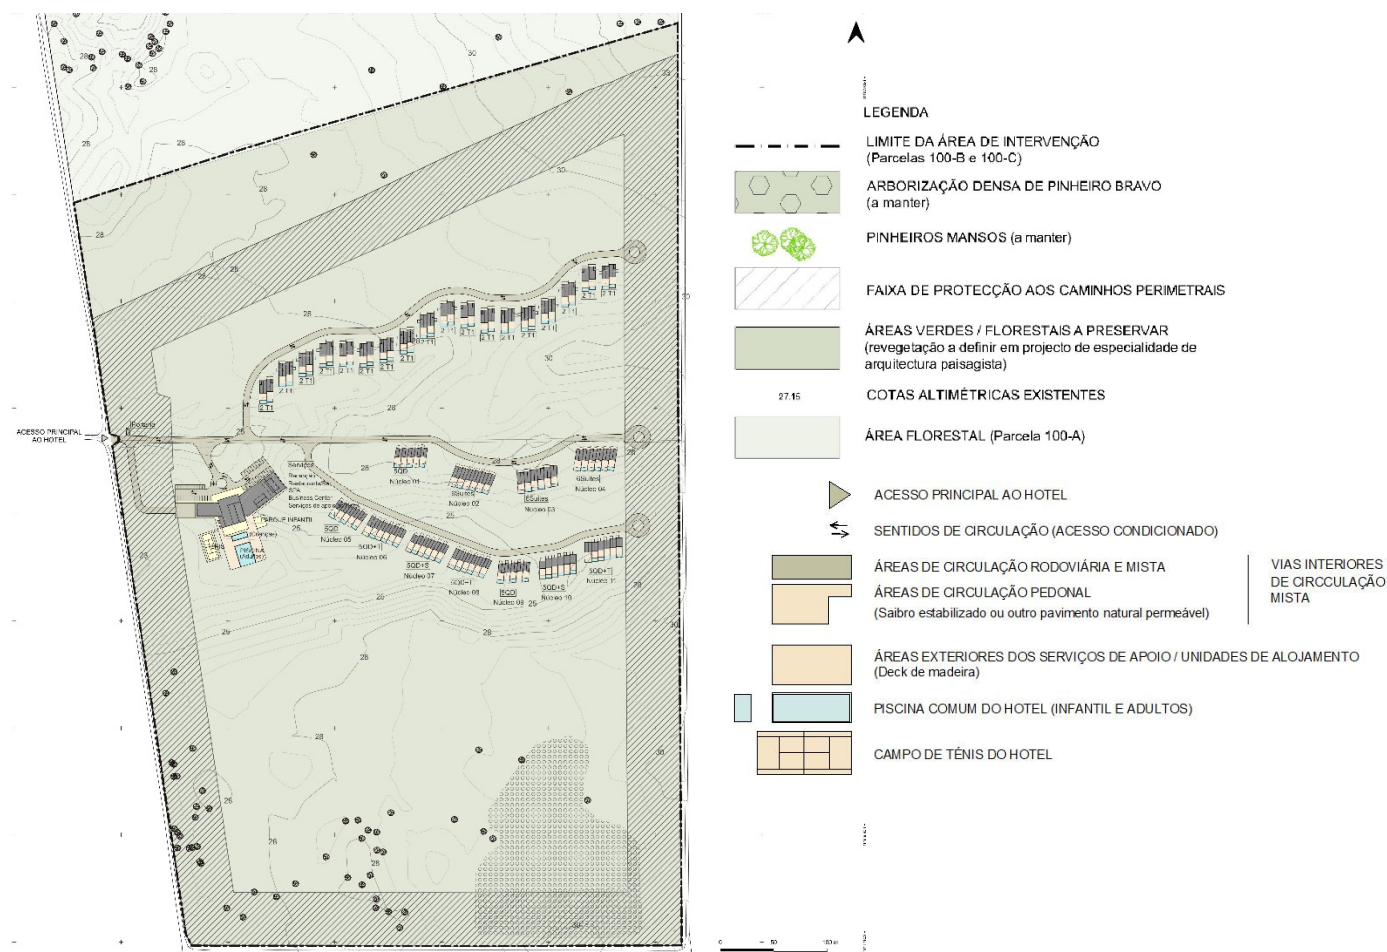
Planta de Implantação do projeto (Pedro Trindade Ferreira/Arq. Viva, 2022)
